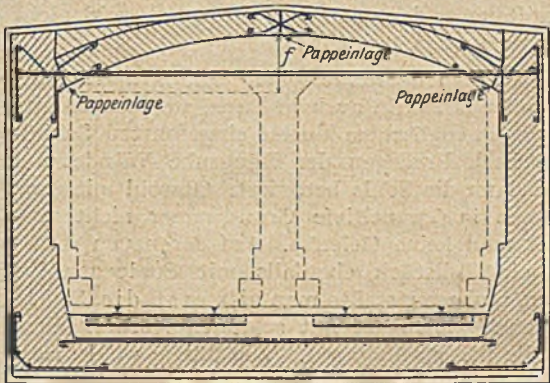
a. Querschnitt eines normalen Unterpflasterbahntunnels jetzt üblicher Bauart (mit vollständiger Bewehrung).
